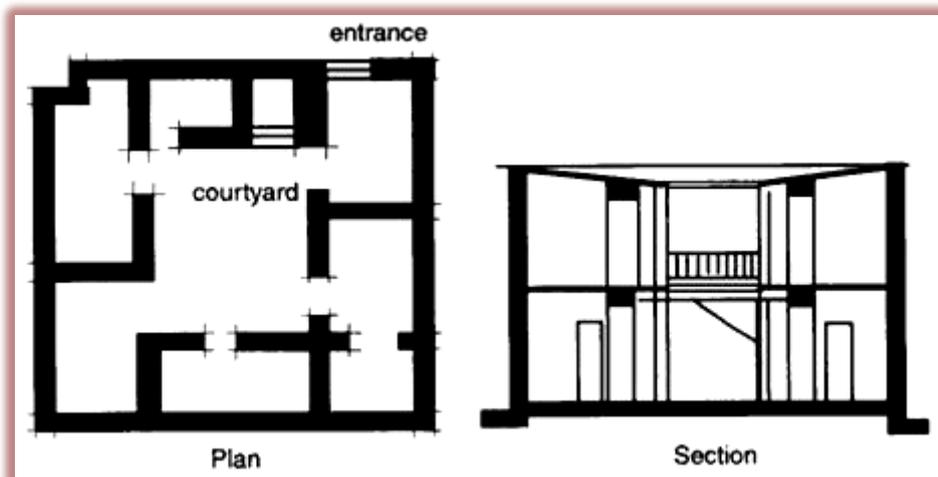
plan et coupe d'une maison de Ur, Mésopotamien
